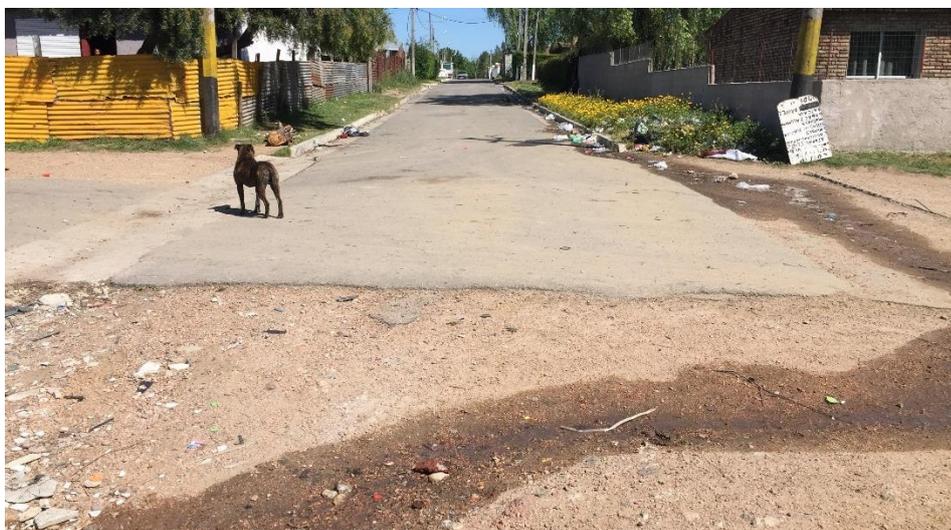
Fotografía sobre Calle 17 Metros con orientación noreste, hacia el Pasaje 122, en la intersección de la Calle 17 Metros y Rambla Costanera.
